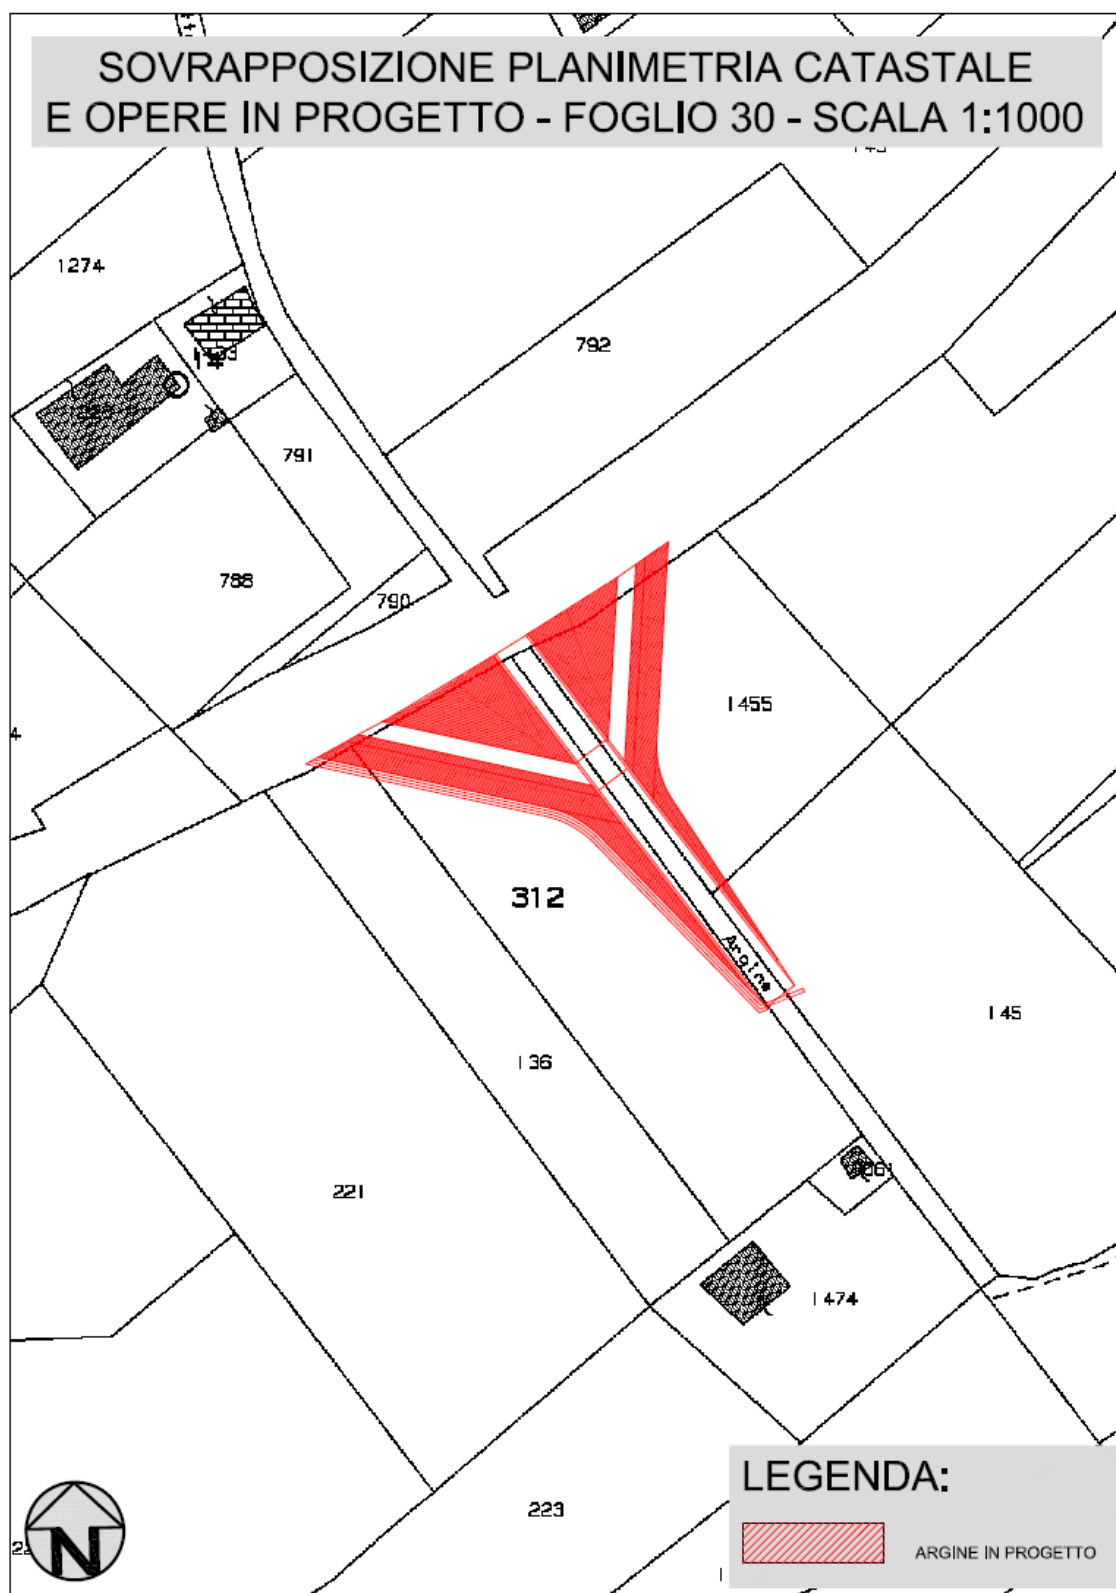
individuazione opere in progetto intervento n. 2 su planimetria catastale
